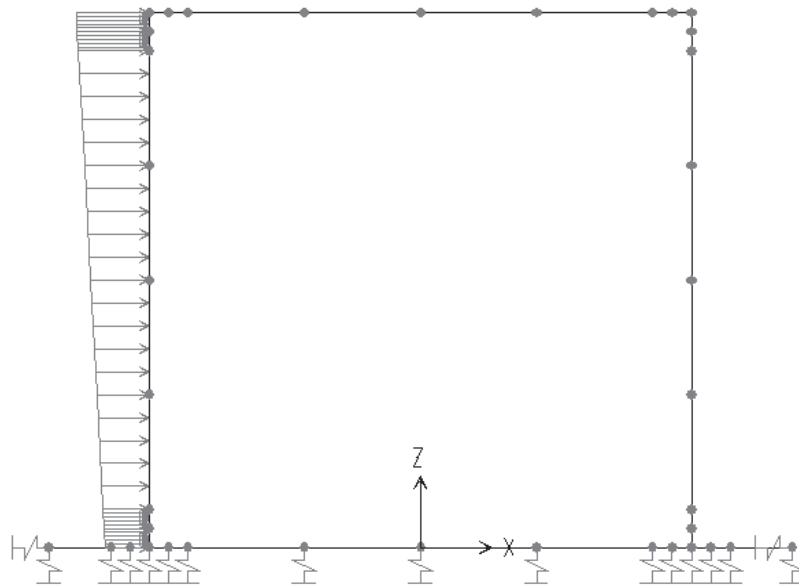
SPINTA DOVUTA DALL’AZIONE VERTICALE DA TRAFFICO SUL PIEDR. SX SQMS
